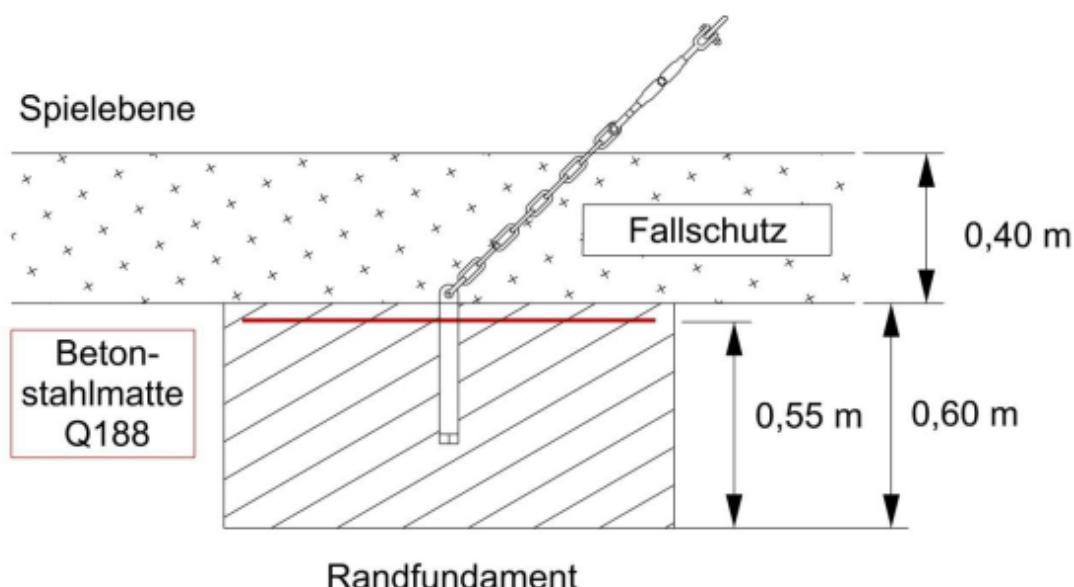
Sezione verticale della fondazione perimetrale (Randfundament)
